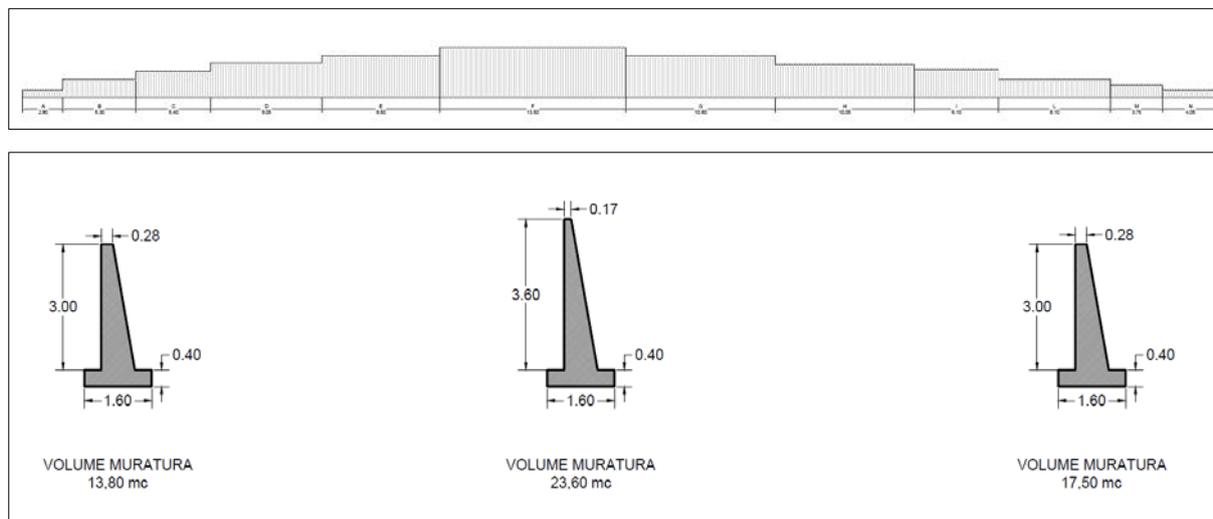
Profilo tipo del muro di contenimento previsto e altezze massime dei muri previste nella porzione centrale del manufatto.
